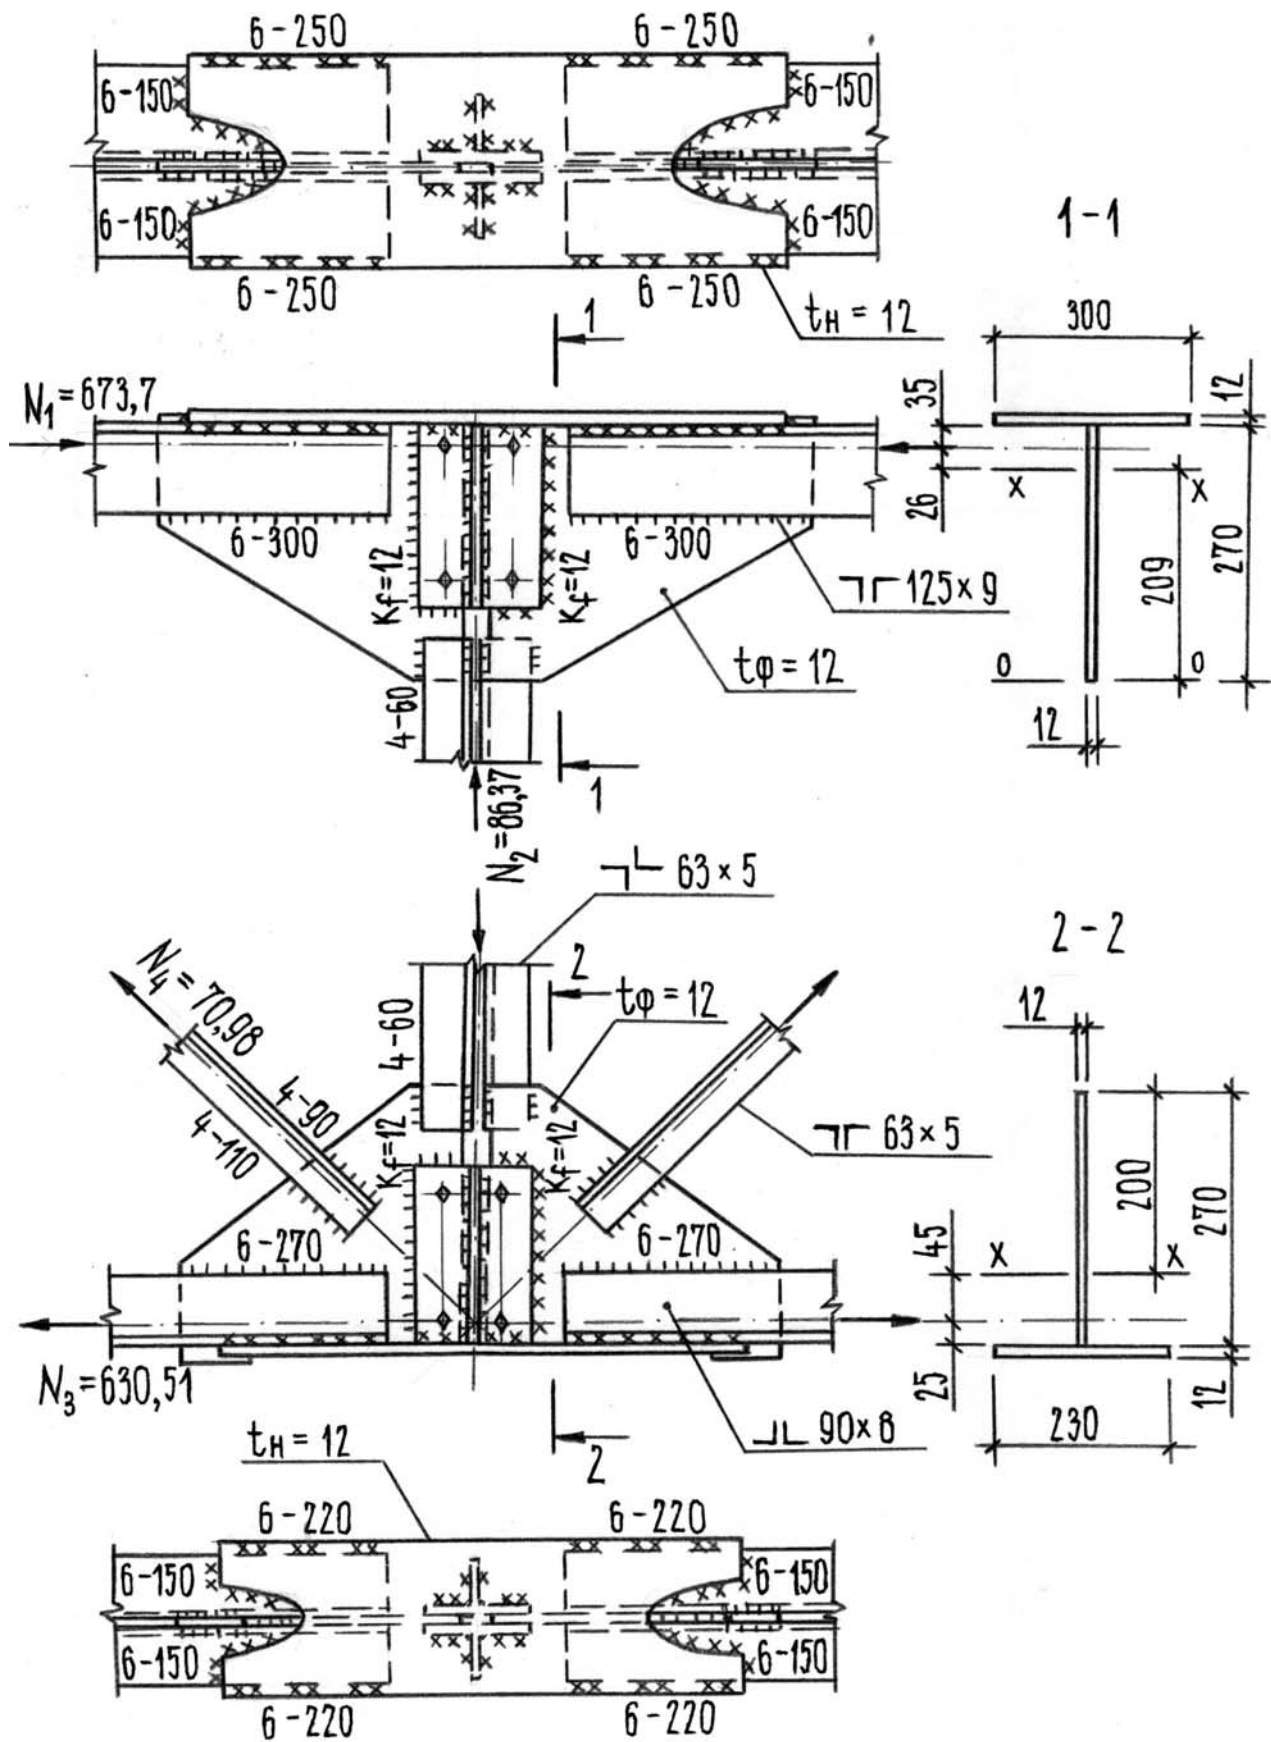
Монтажный узел фермы из парных уголков (пример 4)
